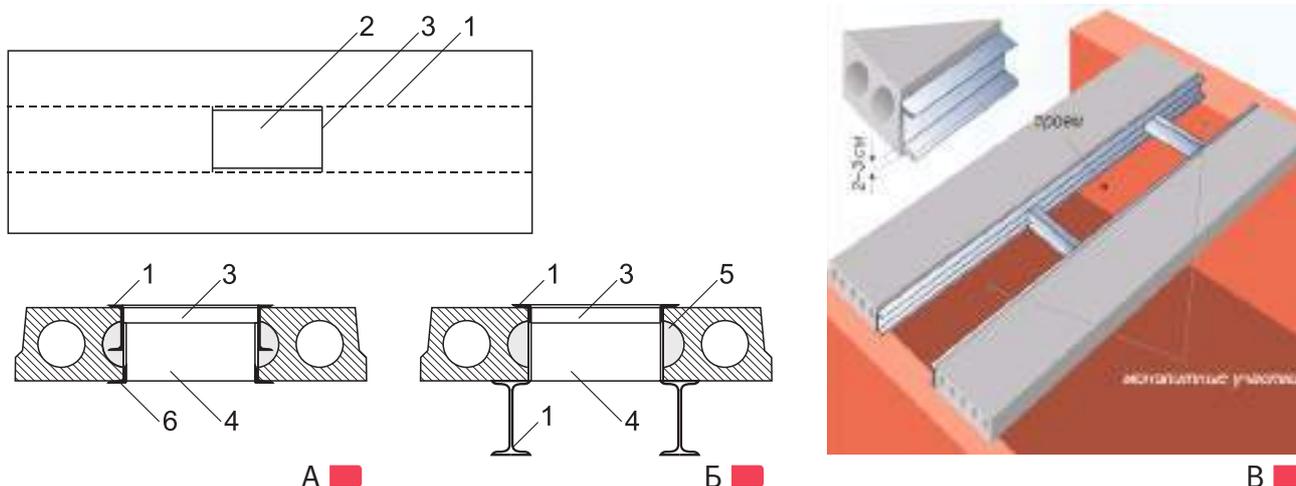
Организация проемов в сборных железобетонных плитах перекрытий: А – в строительном габарите перекрытия; Б – с подведением балок снизу; В – для проема на всю длину плиты: 1 – стальные балки, установленные в пустоты через пробитые пазы либо подведенные снизу, и опирающиеся на ригели и стены; 2 – проем в плите; 3 – рамка из уголка по периметру проема; 4 – обрамление проема из листов; 5 – обетонирование пустот; 6 – подвариваемый уголок
